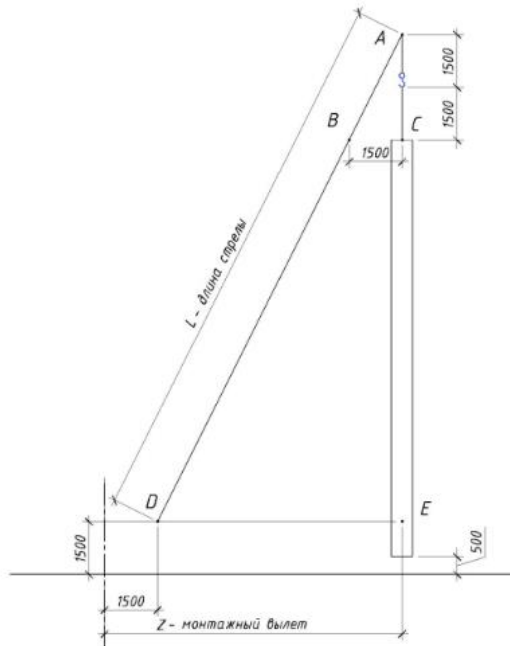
Схема к выбору крана для монтажа колонн
